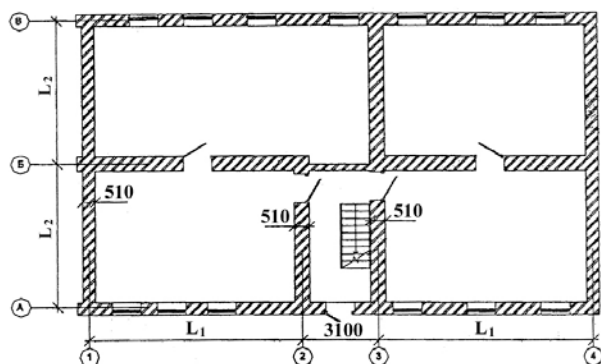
Фрагмент плану 1-го поверху будівлі, яка демонтується
